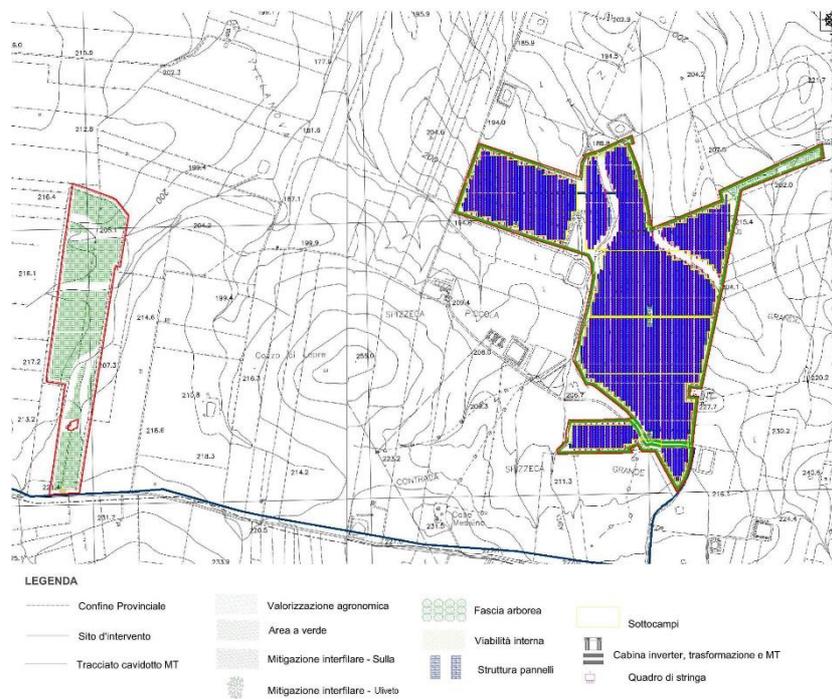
B– Layout dell’impianto ricadente in Contrada Spizzeca con cavidotto
